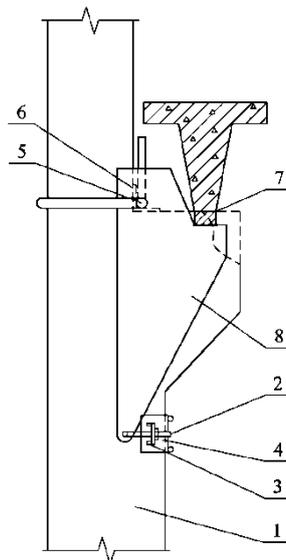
Устройство для усиления колонны: 1 – усиливаемая колонна; 2 – тяж; 3 – упор; 4 – гайка; 5 – ось рычага; 6 – уголок-подкладка; 7 – пластина; 8 – распределительный рычаг
